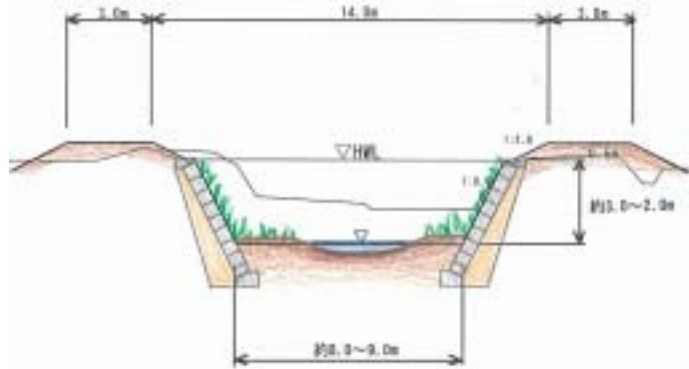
多田川標準断面図（断面図はイメージを表す）
